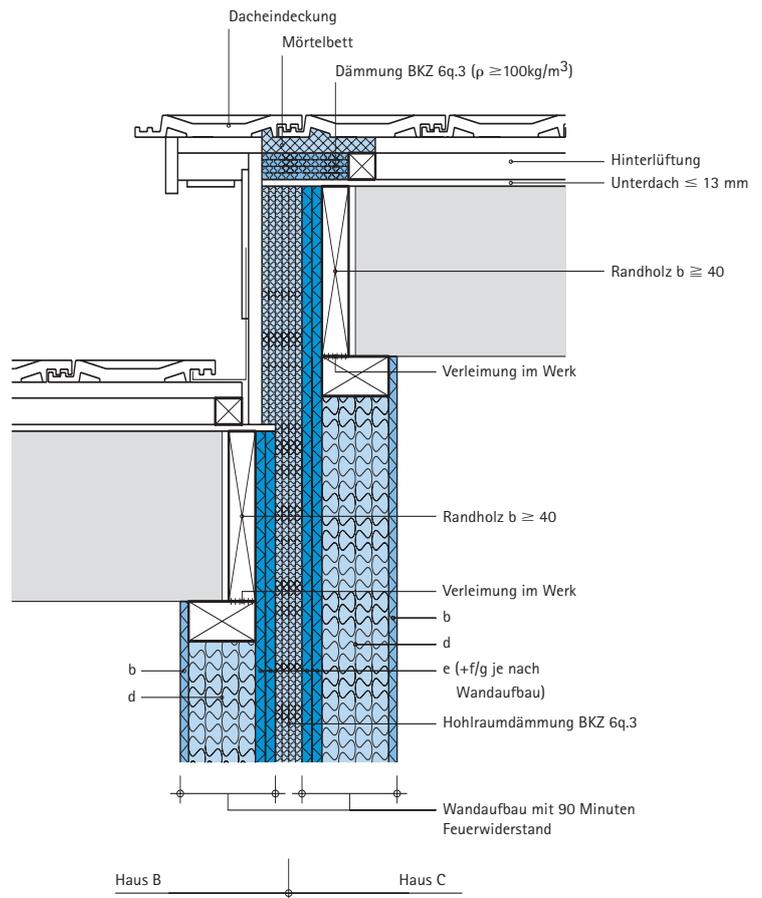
Brandmueranschluss mit versetzter Dachfläche
